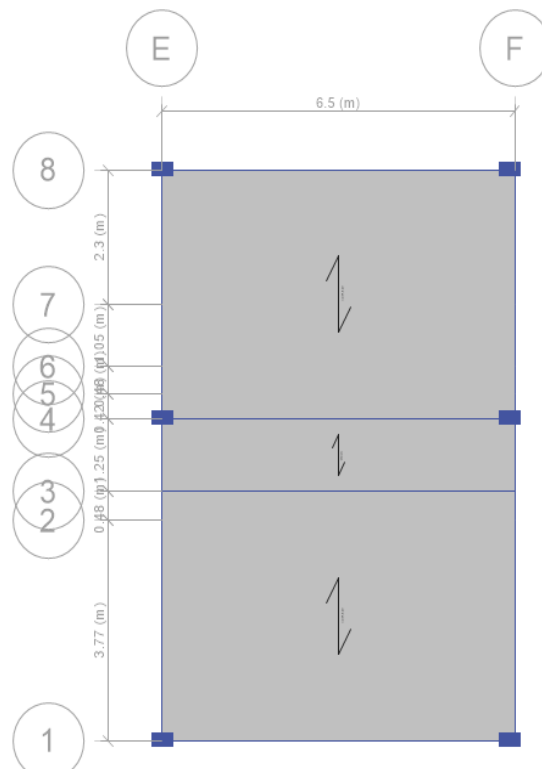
Asignación columnas, vigas y losas – módulo 3.
